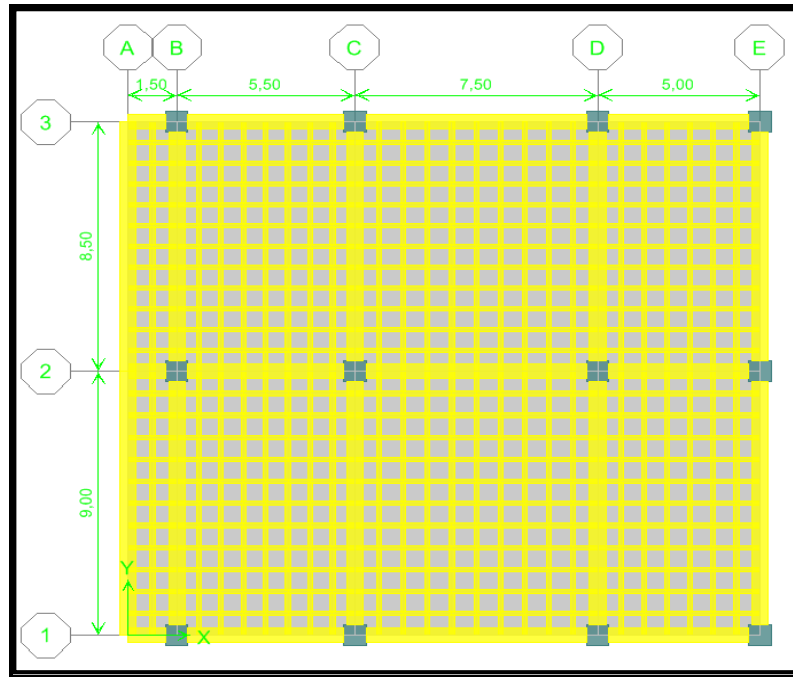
Planta de Nueva Configuración Módulo 1 (Edificio Sur-Oeste)
